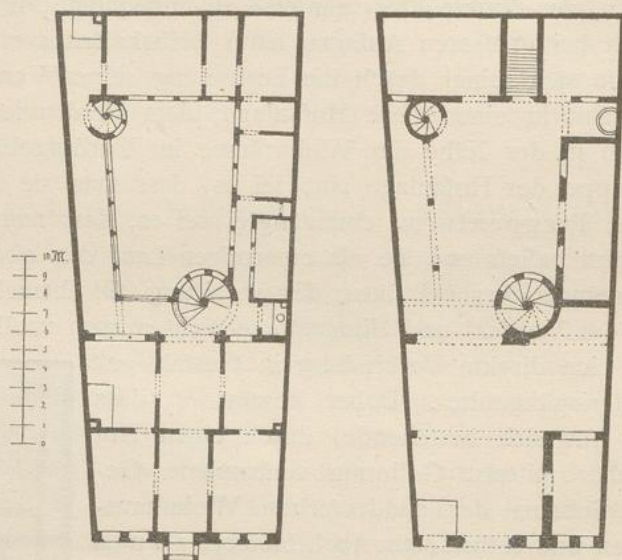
Grundriss des 1. Stocks. Grundriss des Erdgeschosses.
